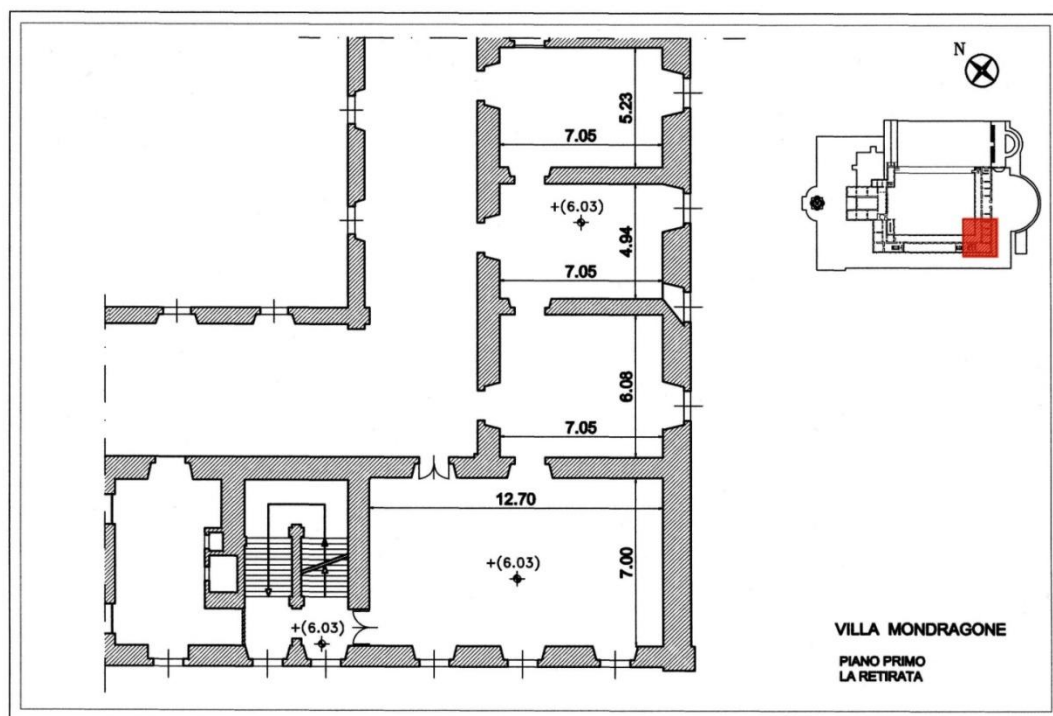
Pianta dell'appartamento, piano nobile, palazzetto della Retirata di Mondragone.
